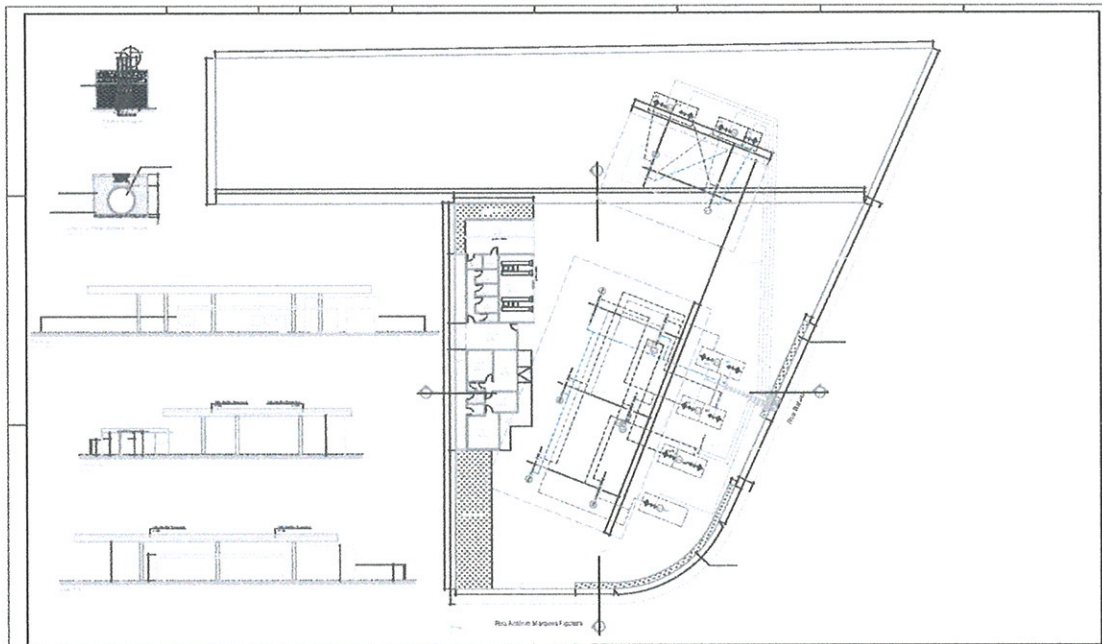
PLANTA (AUTO POSTO VILA FIGUEIRA 01/2019)
